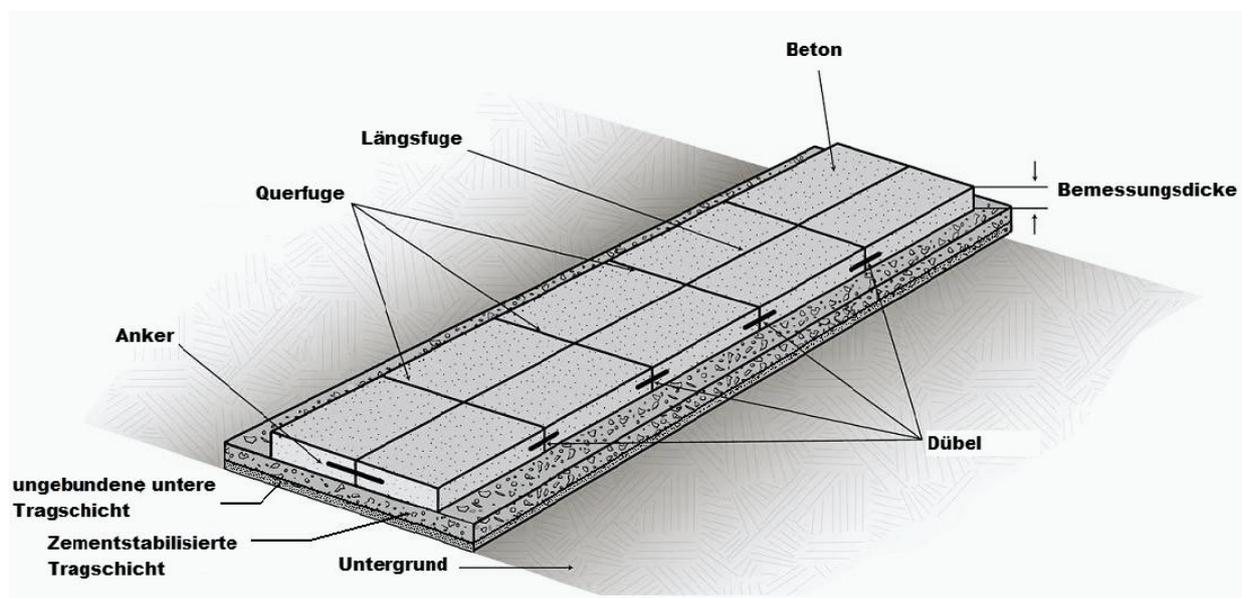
Bauweise für Betondecken in Österreich¹⁰
